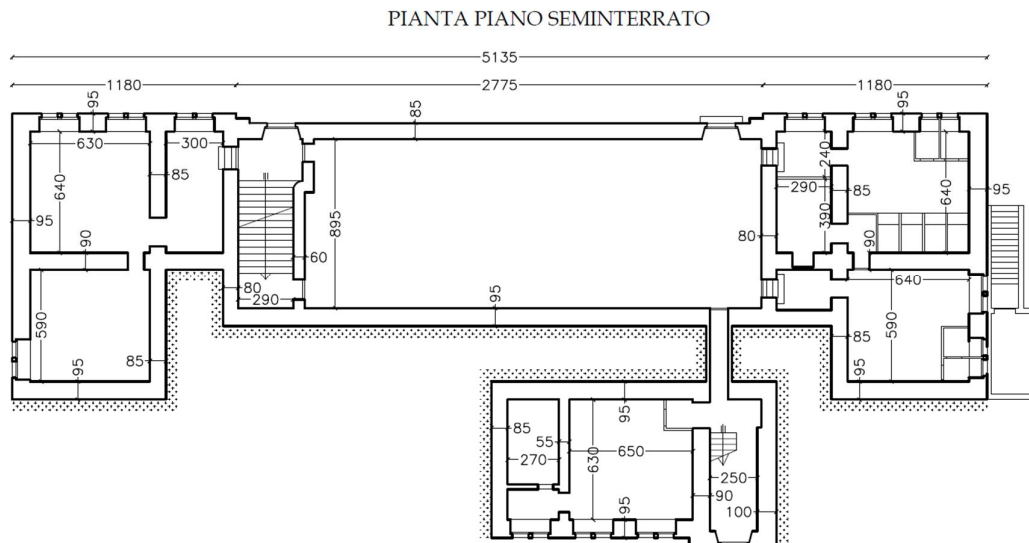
Pianta della palestra e dei locali seminterrati.
